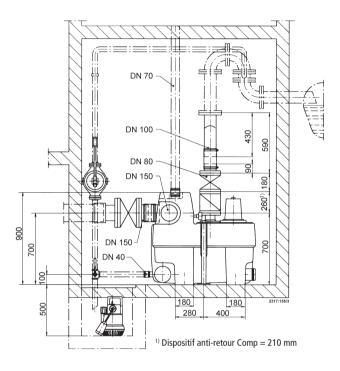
Exemple d'installation des stations de relevage pour eaux vannes
